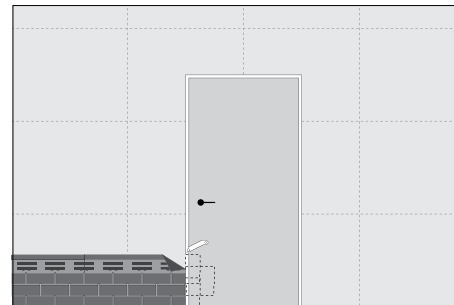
Монтаж фасадной плитки вокруг дверных проемов
